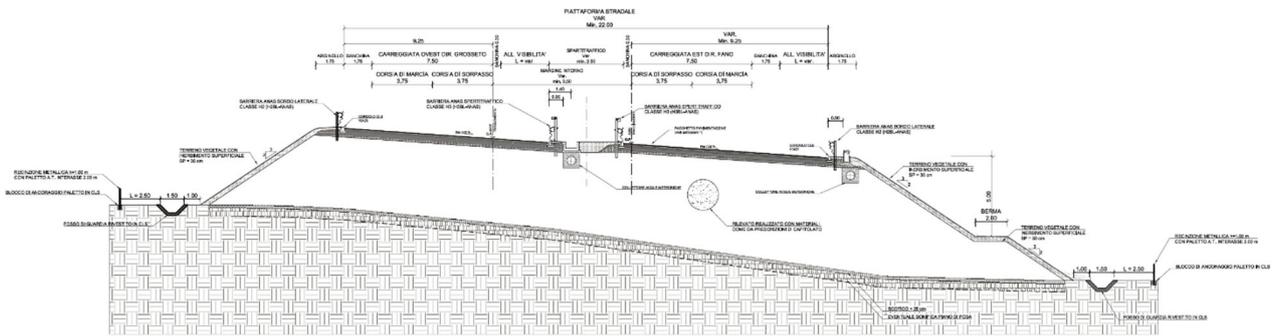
Sezione tipo in rilevato in curva con allargamento
